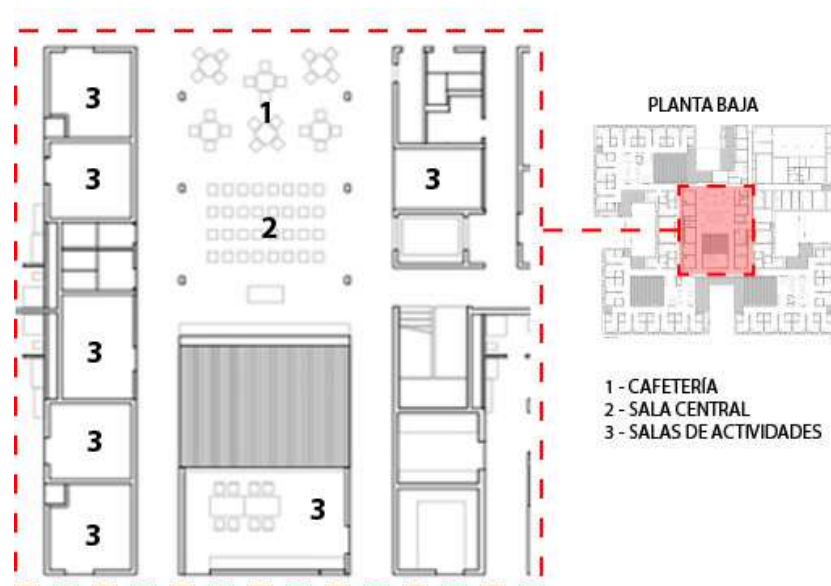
Zona central de uso colectivo generalizado en la planta baja. Fuente: Autor
